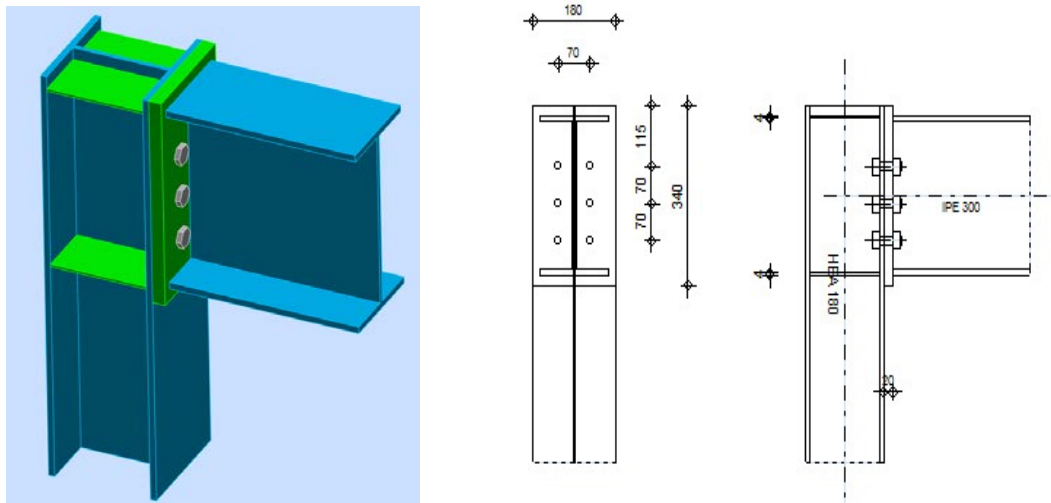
Vista 3D e Pormenores da Ligação Pilar-Travessa
